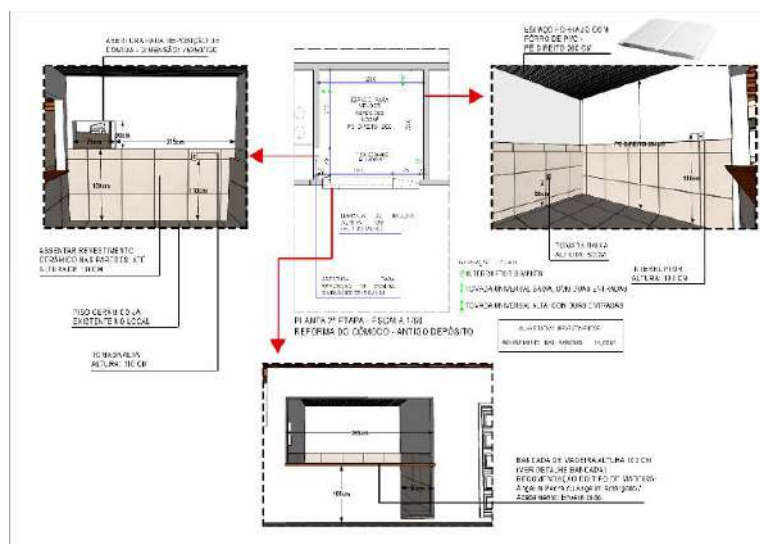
Manual de Instrução - prancha 2ª etapa da obra (Família 4)
